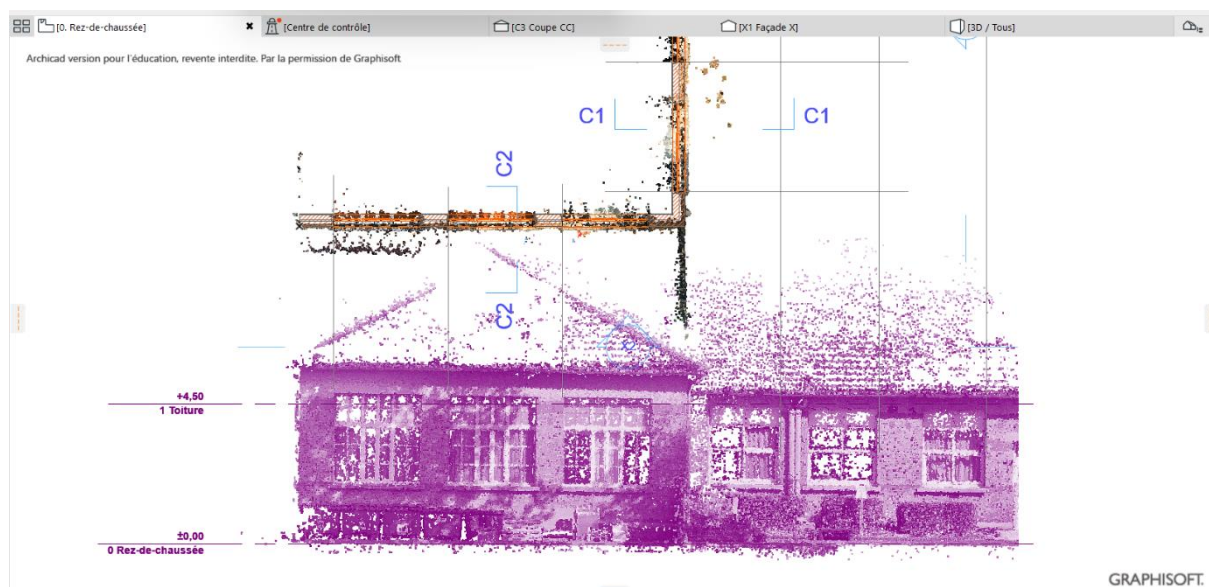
Dessin en plan avec trace de la façade Sud du bâtiment
